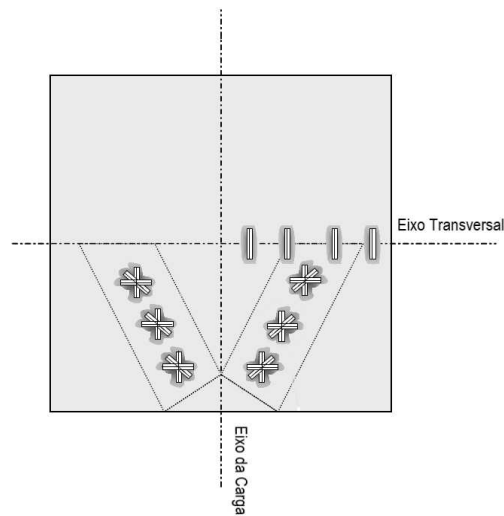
Instrumentação do S1-2 - adaptado de Sankovich (2003)
